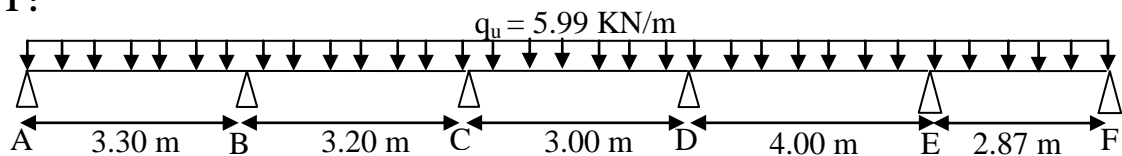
Schéma statique du type 1 des poutrelles
